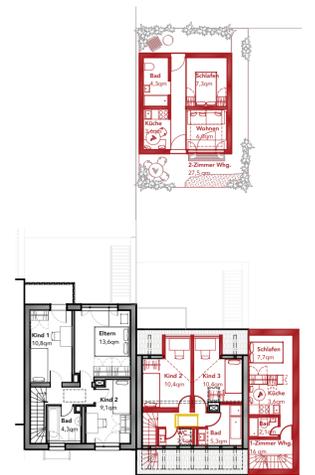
Bestands- und Weiterbau, Grundrisse
